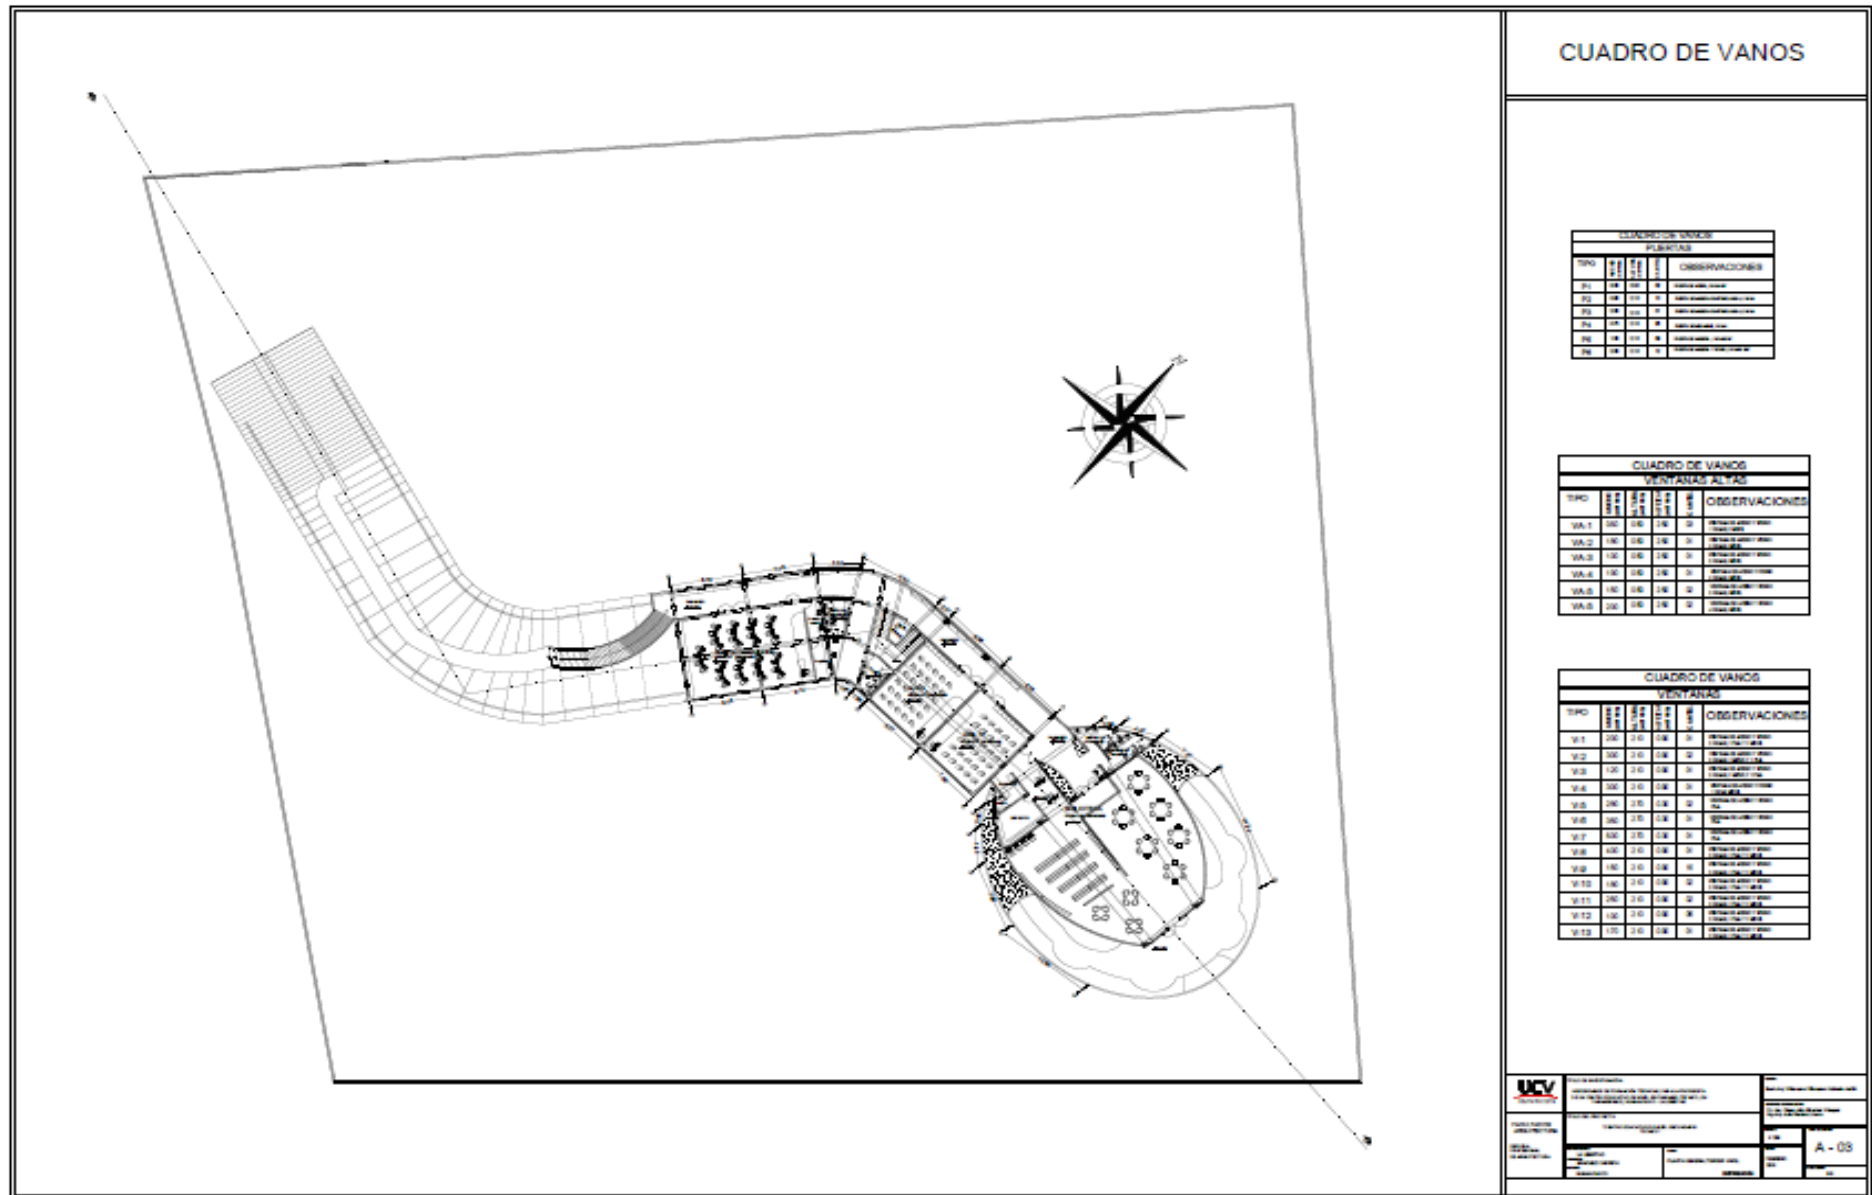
Plano de Distribución – Plano N° 07 - Lamina A-03
